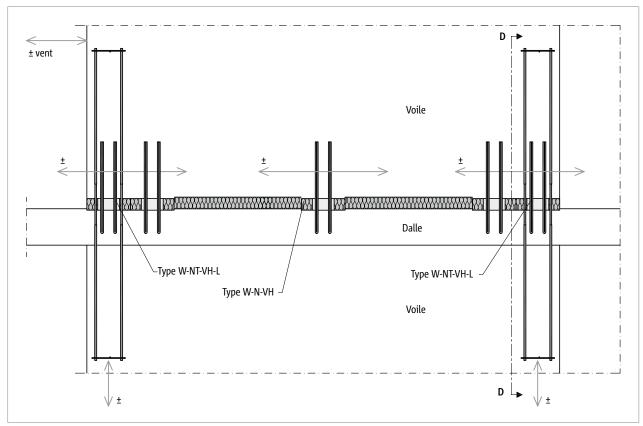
Schöck Sconnex® type W: variantes de produit combinées pour le raccordement d'un mur stabilisant sollicité horizontalement
